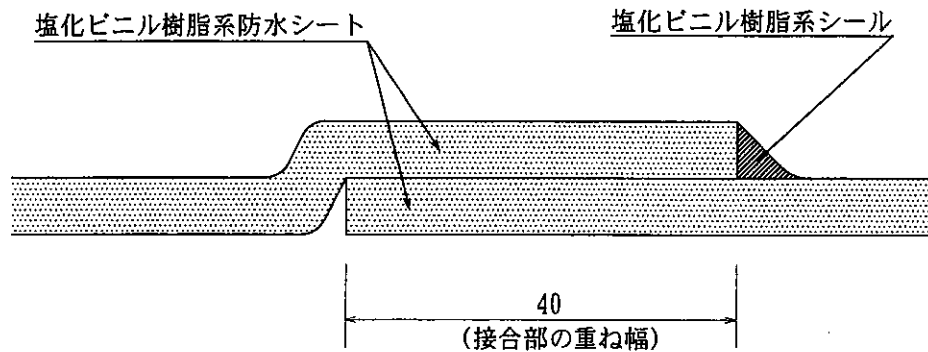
施工図 (塩化ビニル樹脂系防水シートの目地部断面)
